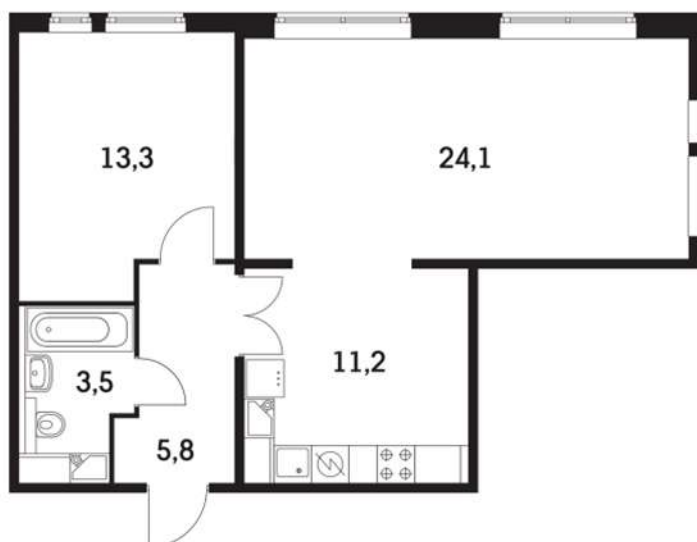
Вариант планировки двухкомнатной квартиры.
